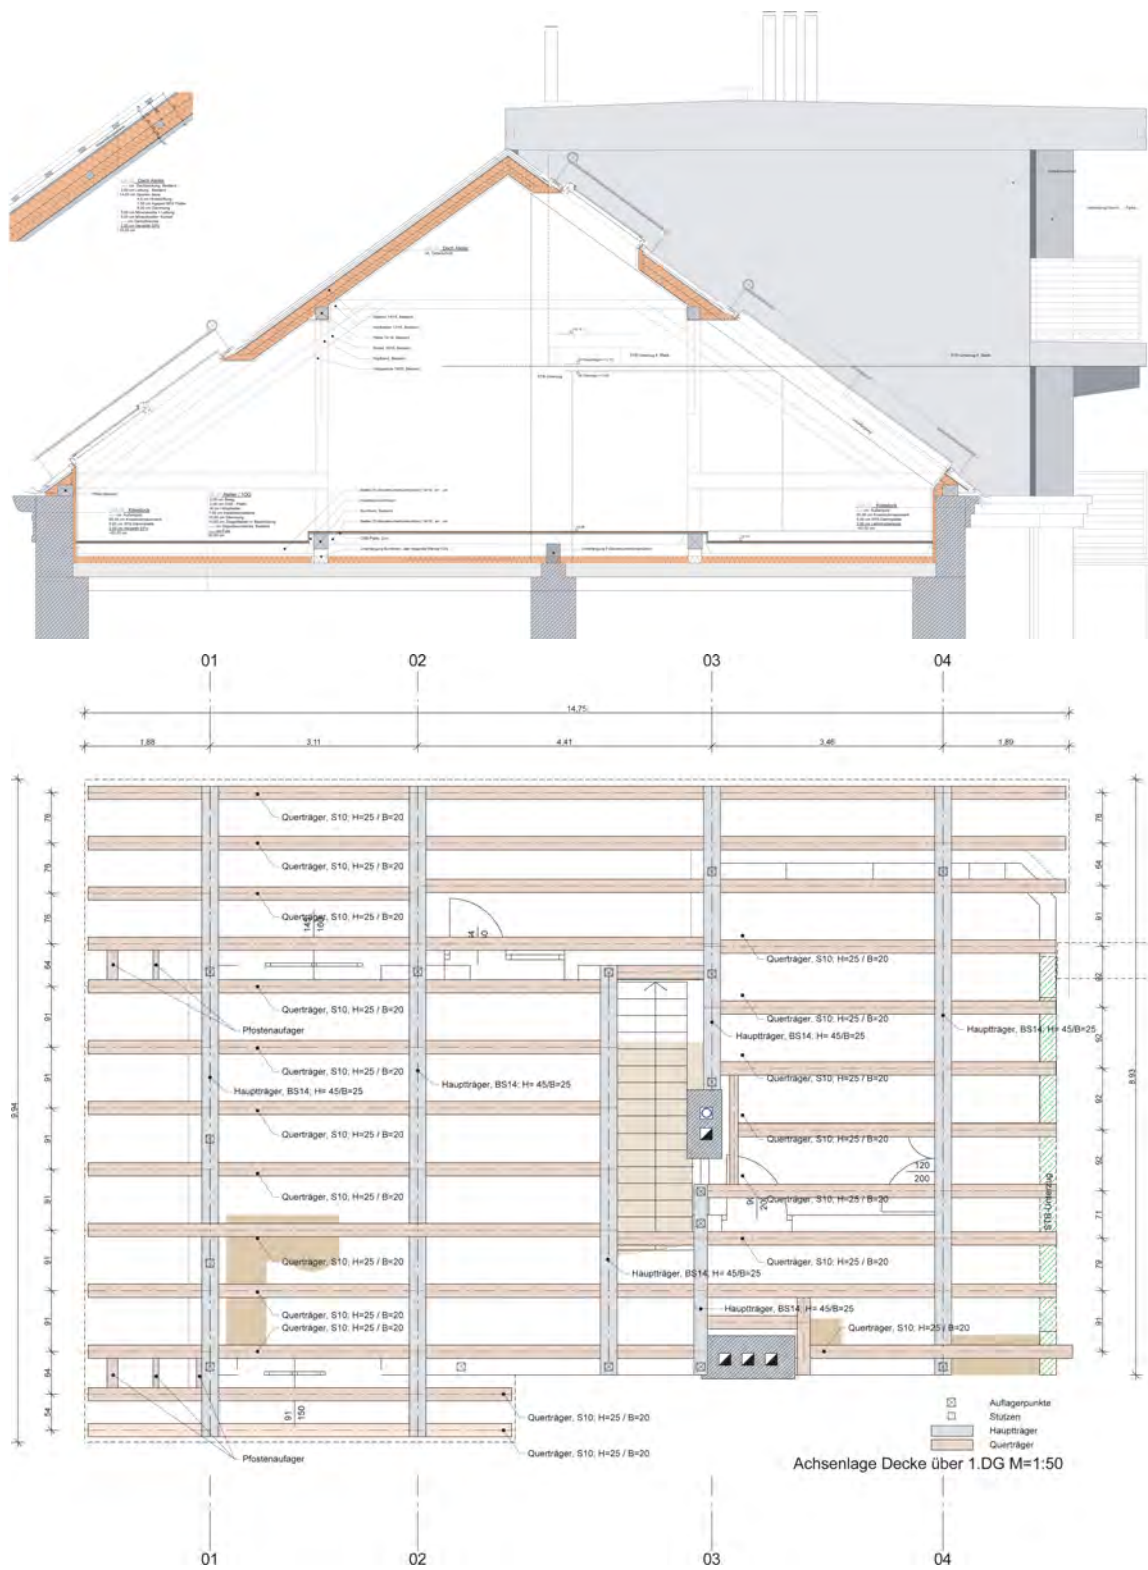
Schnitt durch Satteldach und Achsenlage Decke über 1. Dachgeschoss
